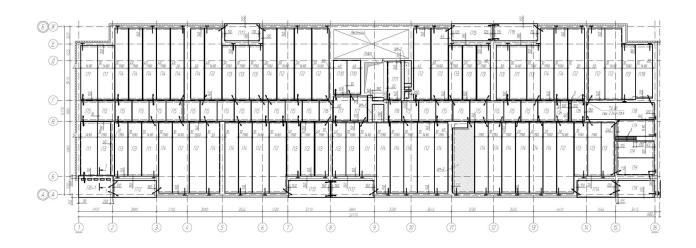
схема расположения плит перекрытия типового этажа
